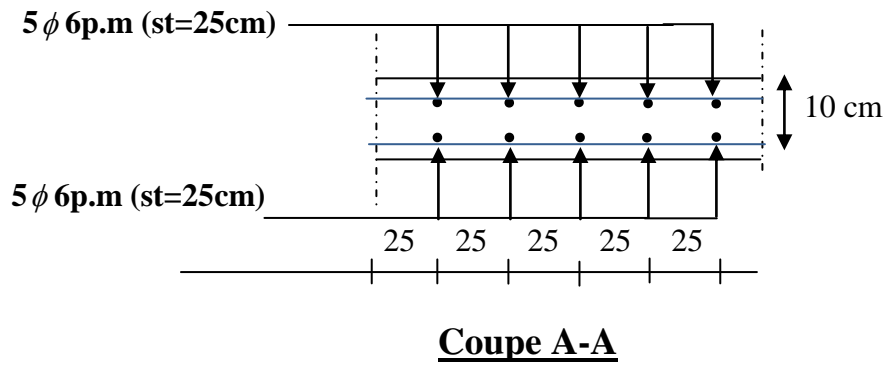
Ferrailage d’une section longitudinale de l’acrotère
